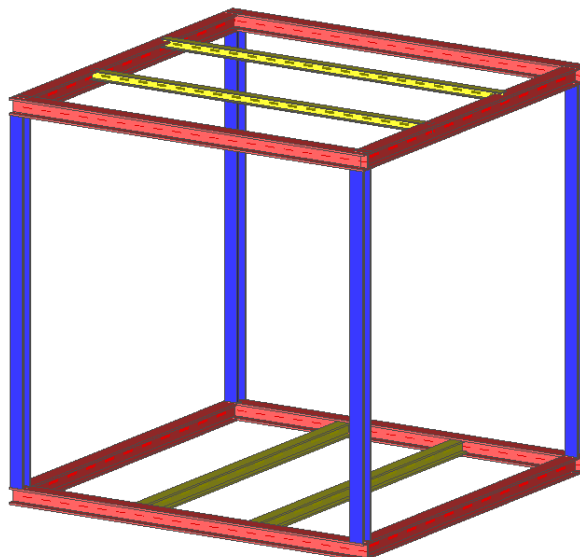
Příklad možného složení modulů - základní typ Schöck Isokorb KST 16
